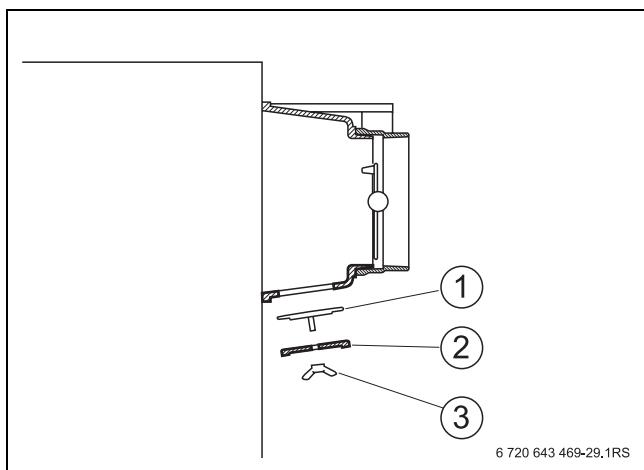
Крышка люка для чистки на сборном коллекторе дымовых газов
